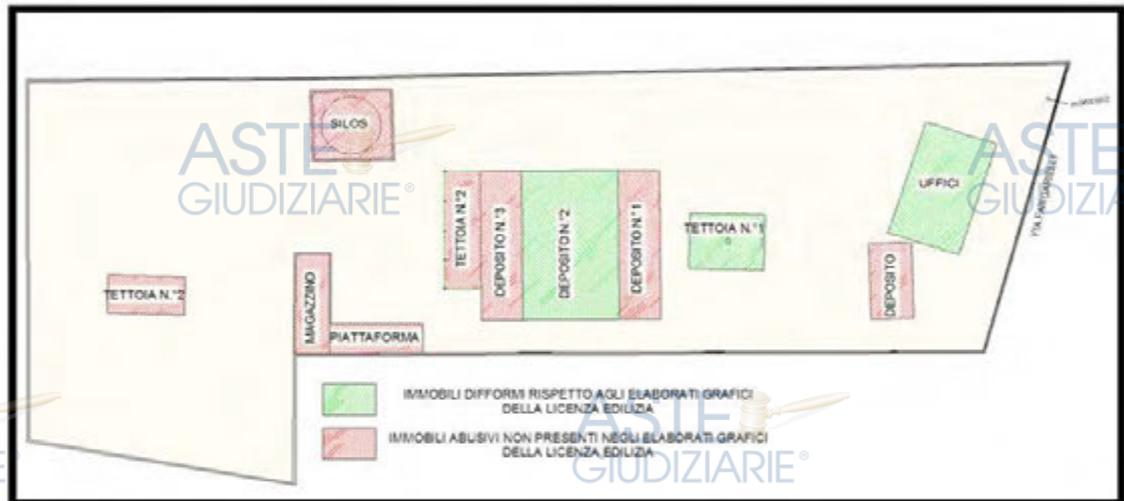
Planimetria generale elaborata dal sottoscritto
